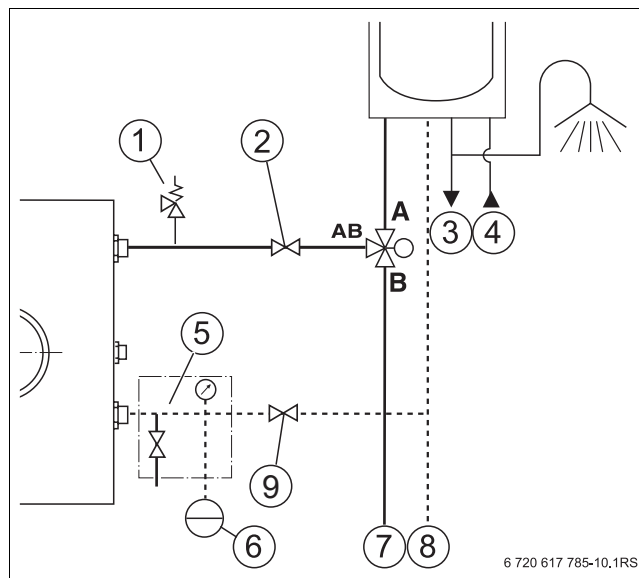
Montage externes 3-Wege-Ventil/3-Wege-Ventil
